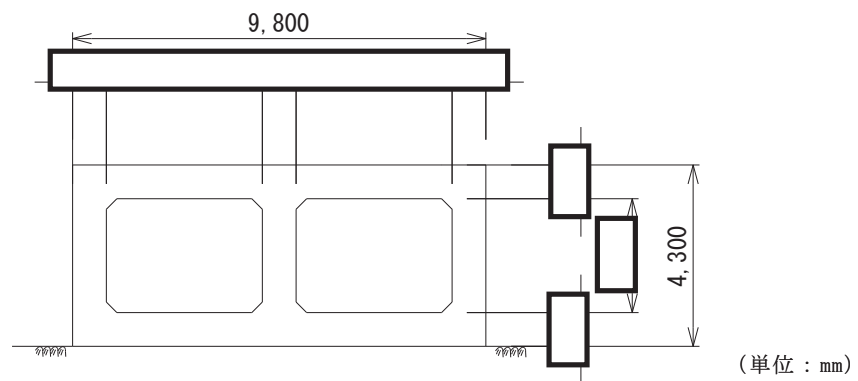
第 1 号機取水路の構造図 (A-A 断面)
